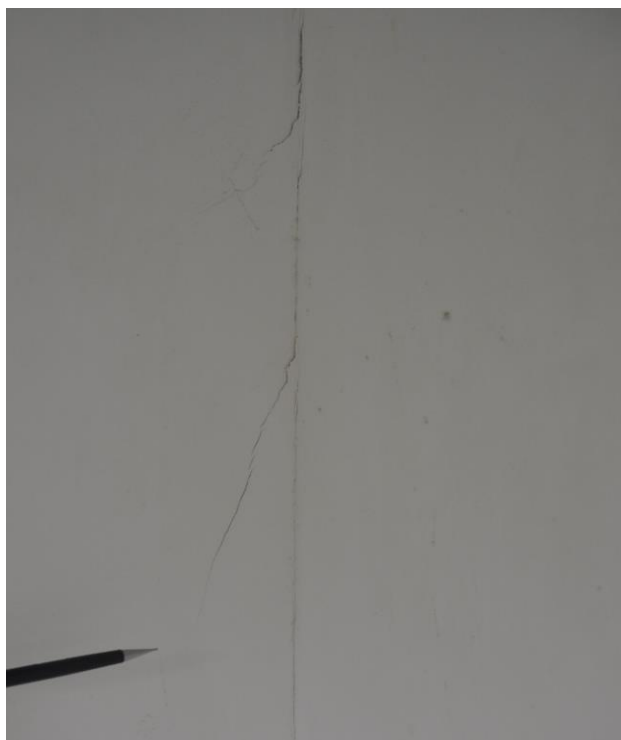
Fissuras no Encontro Entre Alvenarias
